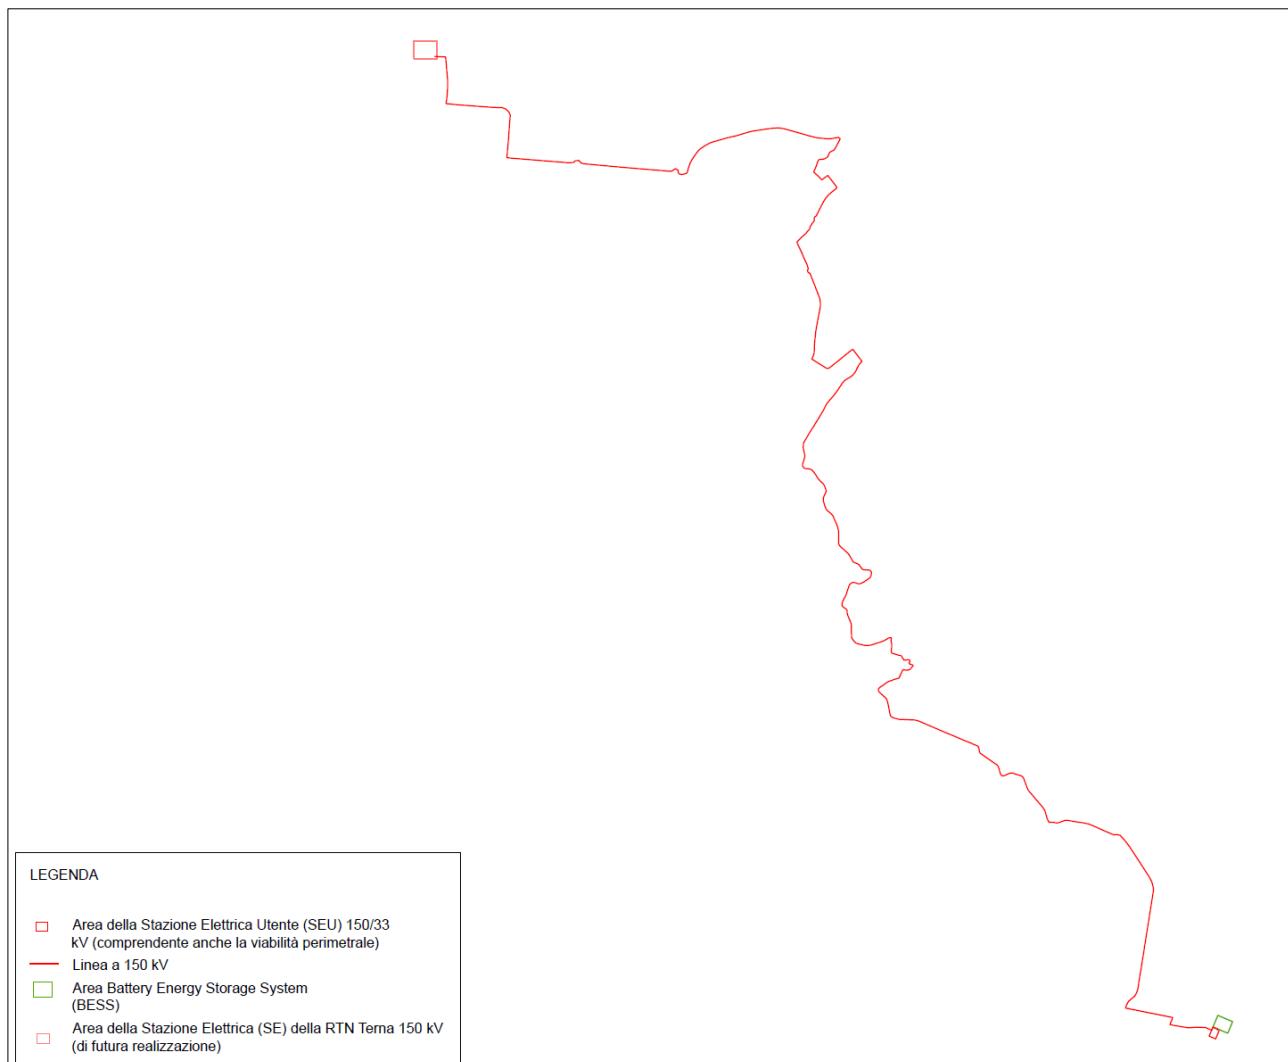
Planimetria generale di distribuzione linea a 150 kV
